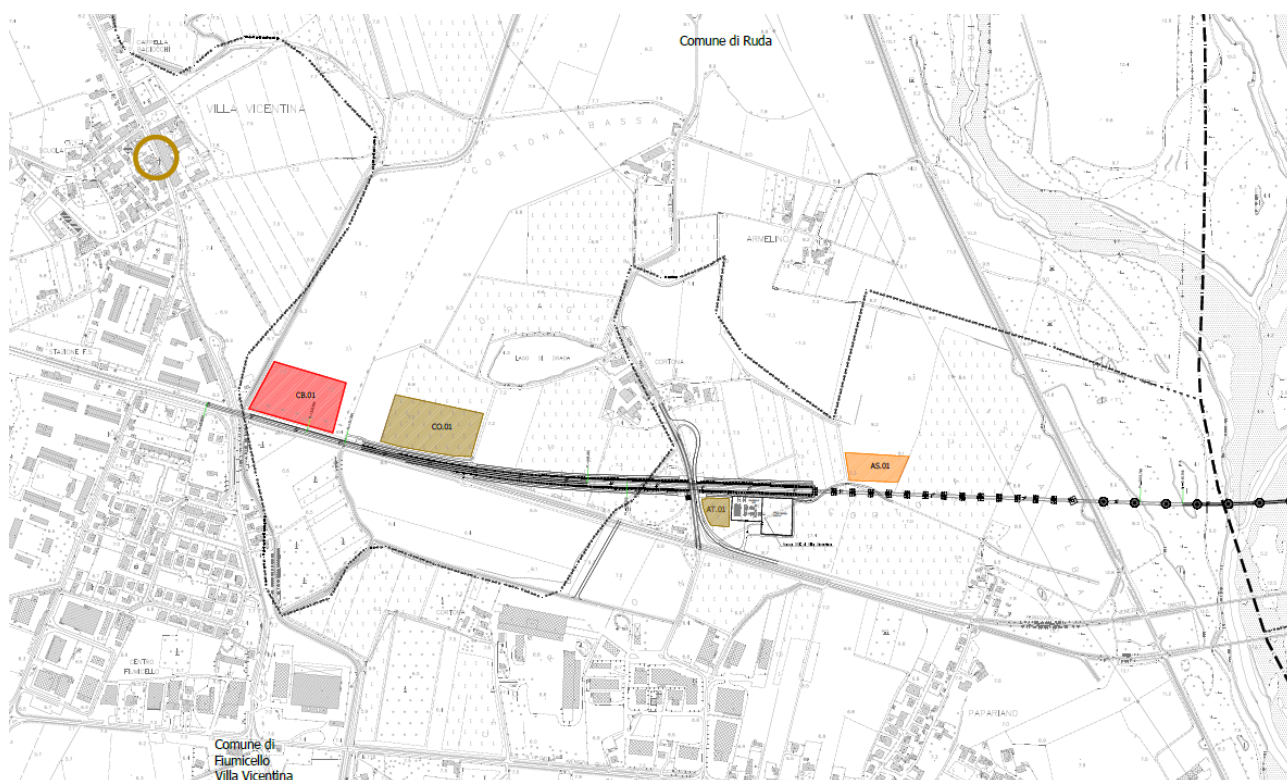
Localizzazione dei cantieri del primo tratto dell'intervento "Variante Isonzo"
